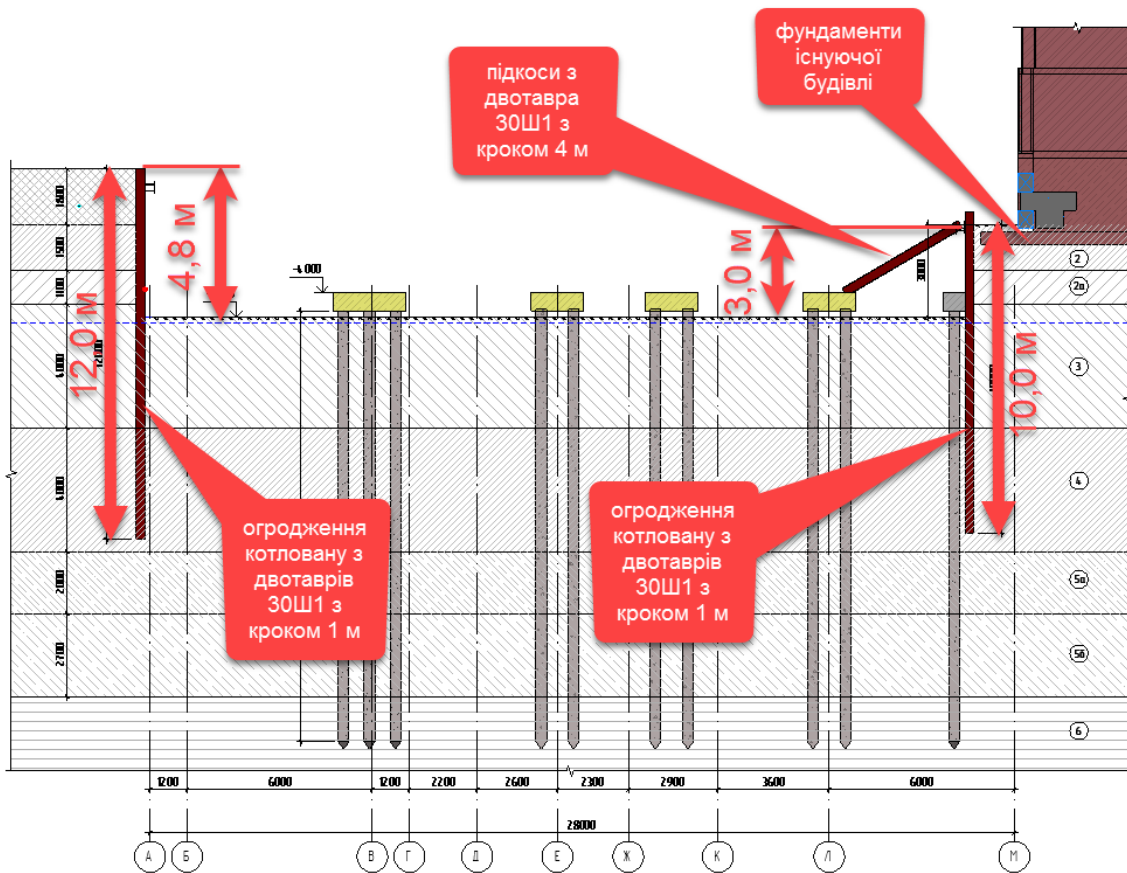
Переріз 1-1 (існуюча п'ятиповерхова будівля з мансардним і підвальним поверхами та баштовий кран для новобудови вздовж осі «А»)
